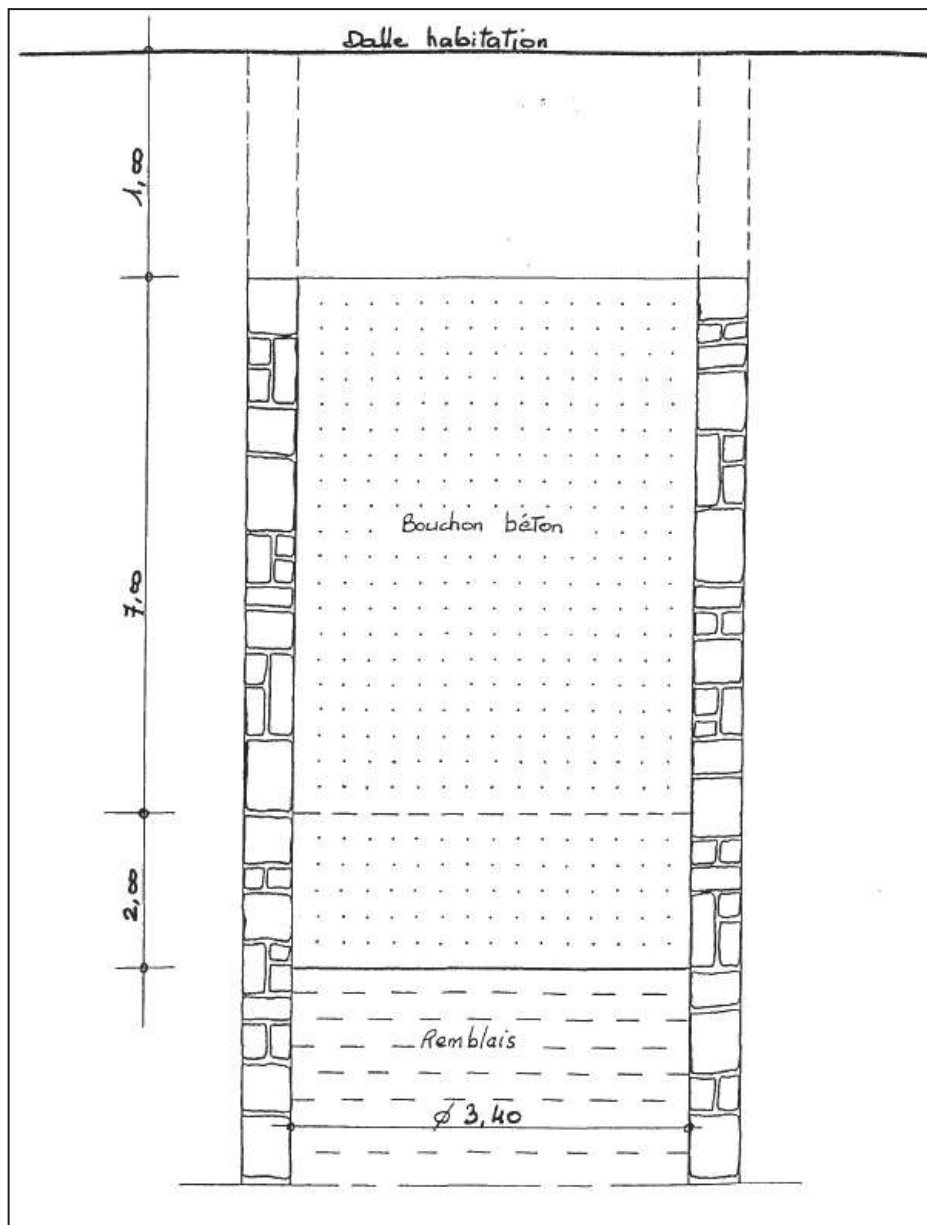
Schéma de mise en place du bouchon béton du puits Neuf de Bouxhors
